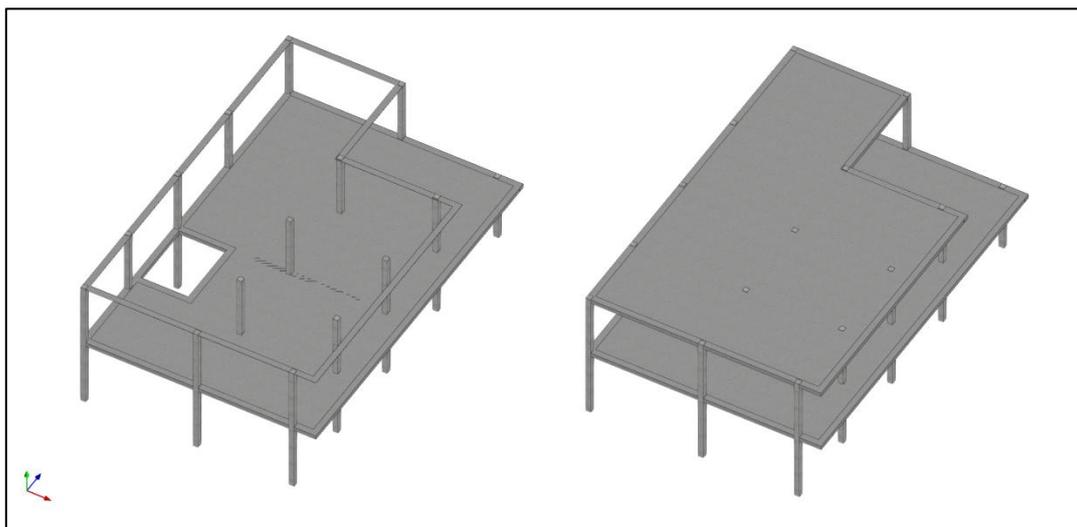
16. Recorte de pantalla, Vistas 3D estructura en Cypecad
